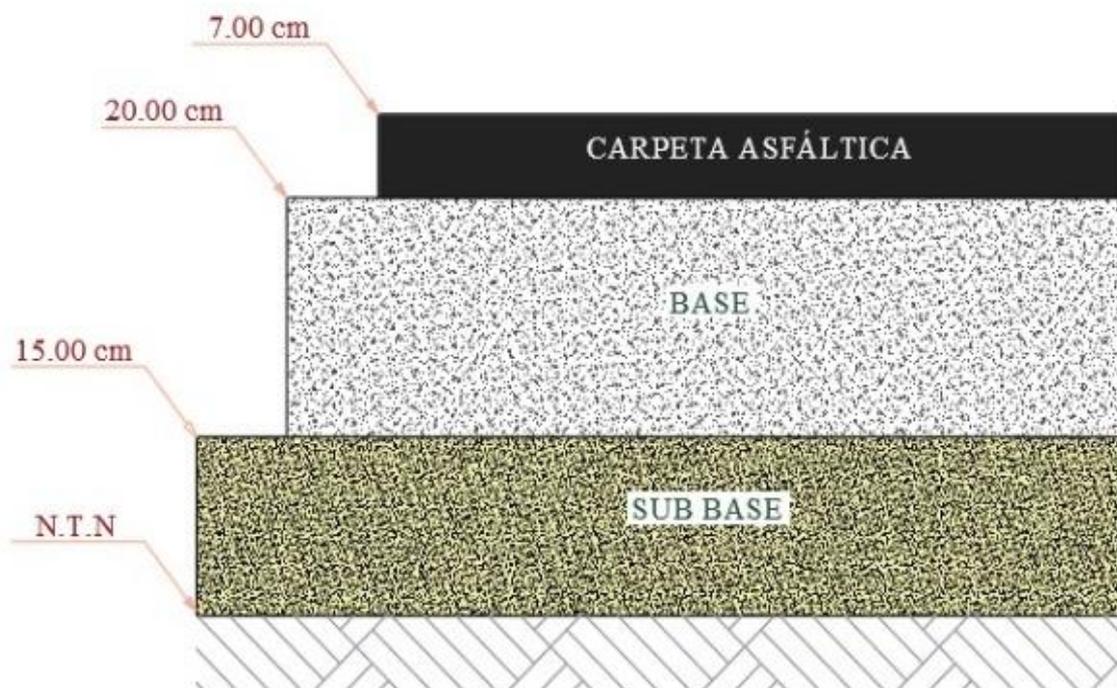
Diseño de Pavimento Flexible - Av. 5 de Abril
